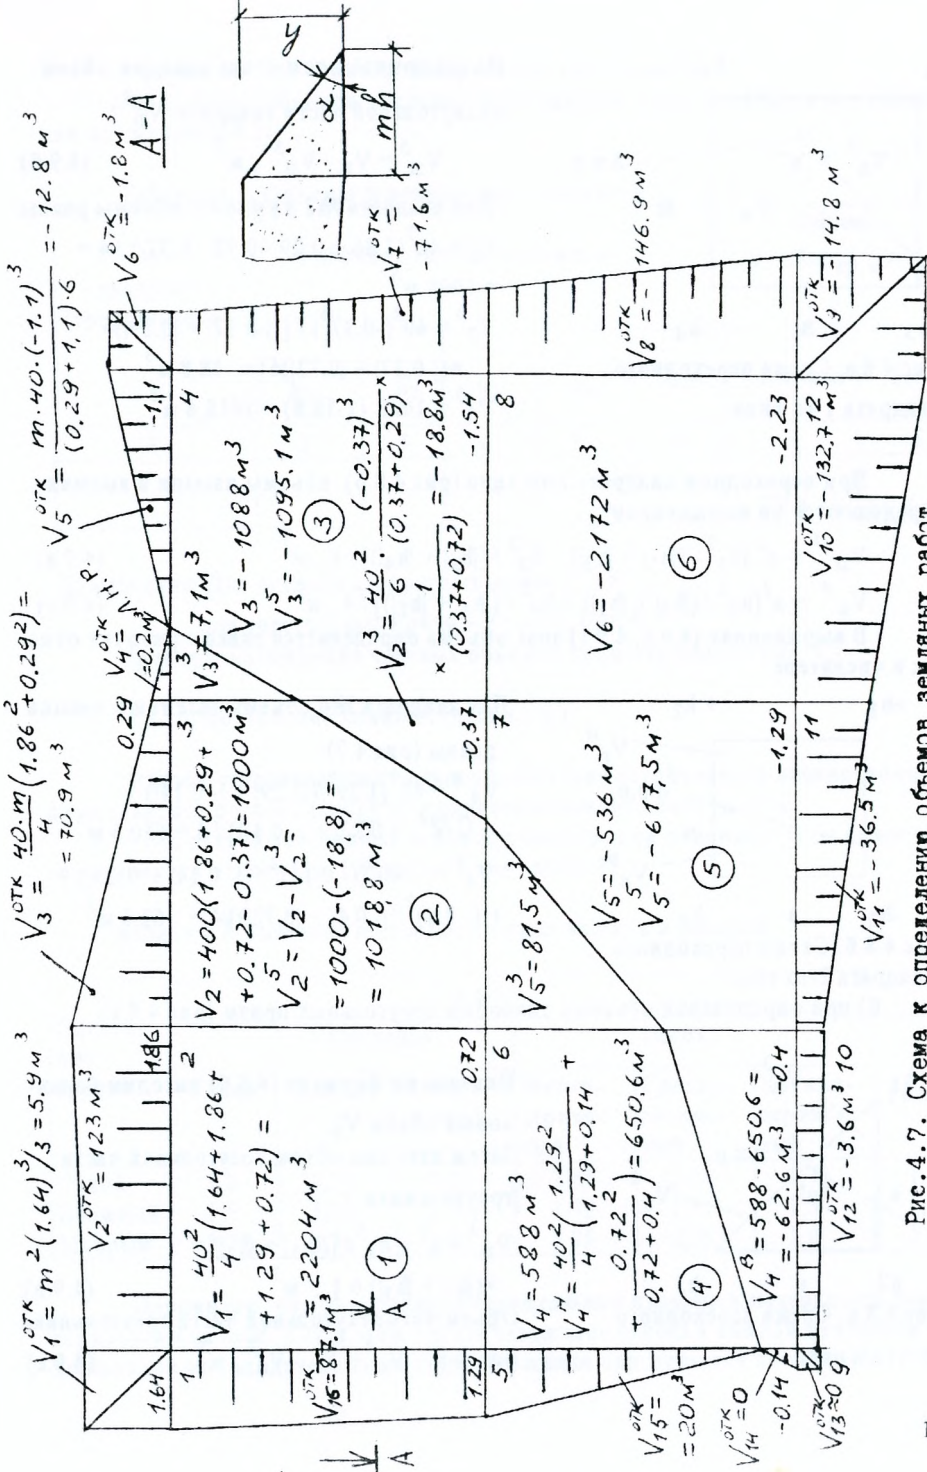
Схема к определению объемов земляных работ при планировке строительной площадки
